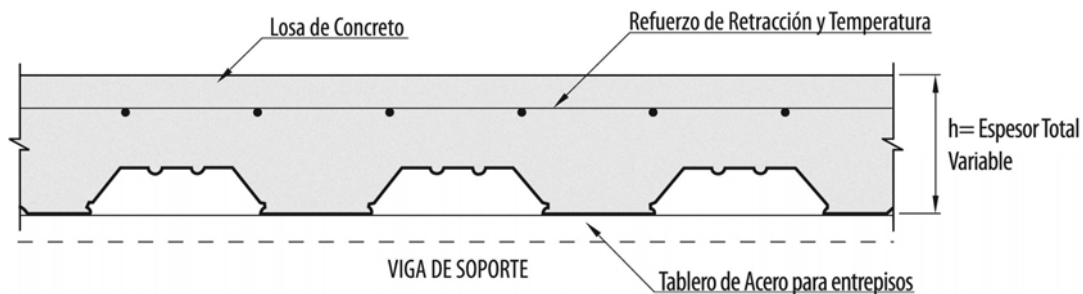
Sección transversal de losa o entrepiso en comportamiento compuesto con un tablero metálico
